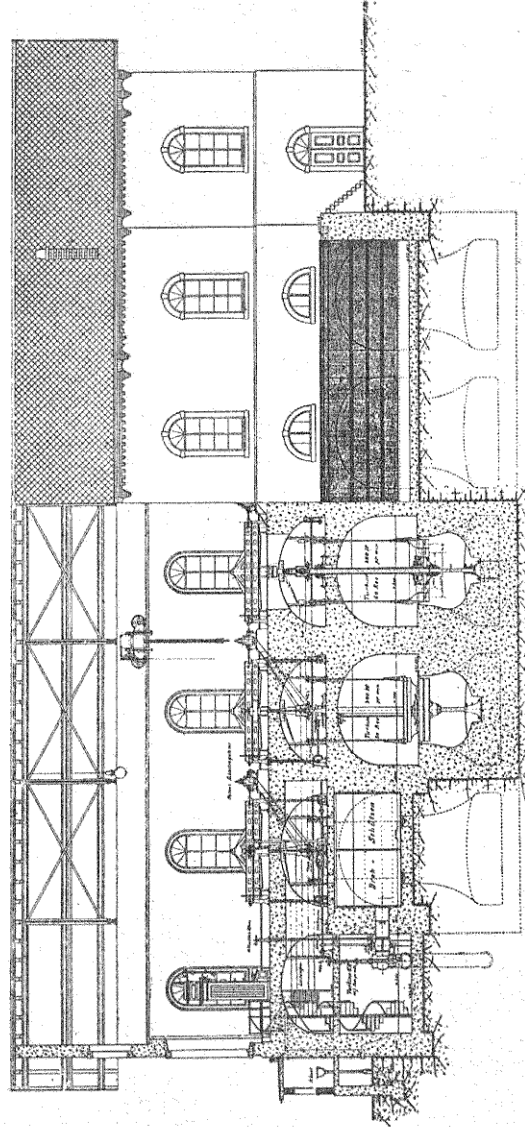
Coupe longitudinale de la station centrale de Rathausen.
